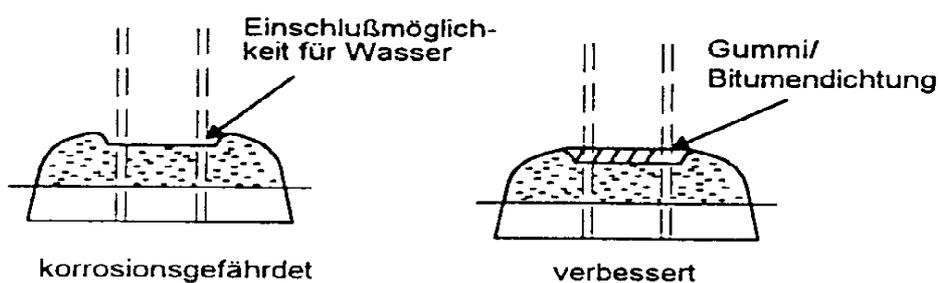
Übergangsstelle Stahl/Beton und Abdichtung
